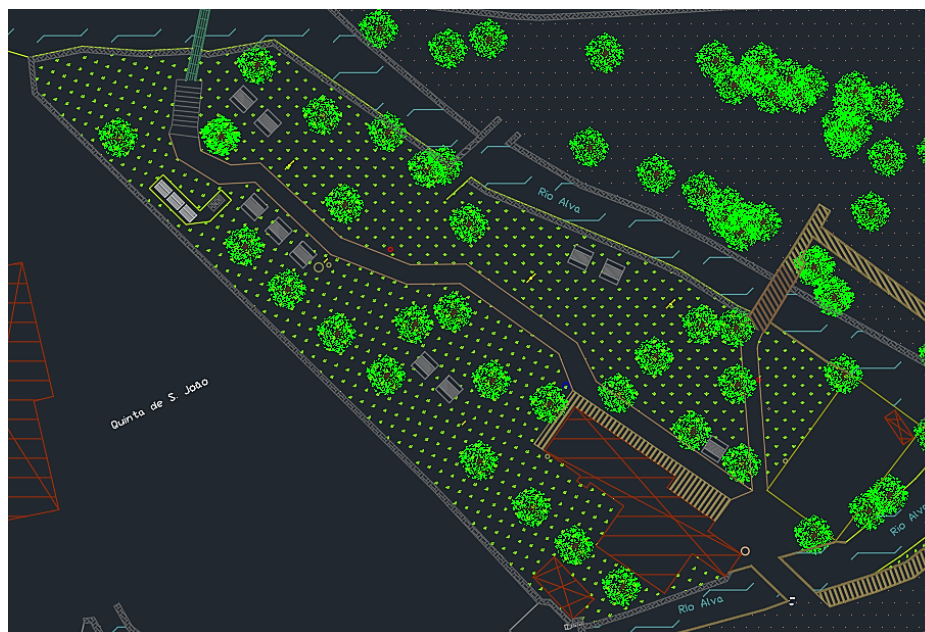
Planta com as soluções para a zona Z1 (Fonte: AutoCad Civil 3D)
